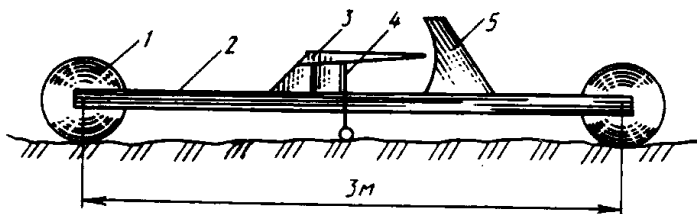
Колесная рейка: 1 – опорное колесо; 2 – рейка; 3 – стрелка; 4 – шток с контрольным колесиком; 5 – шкала.
